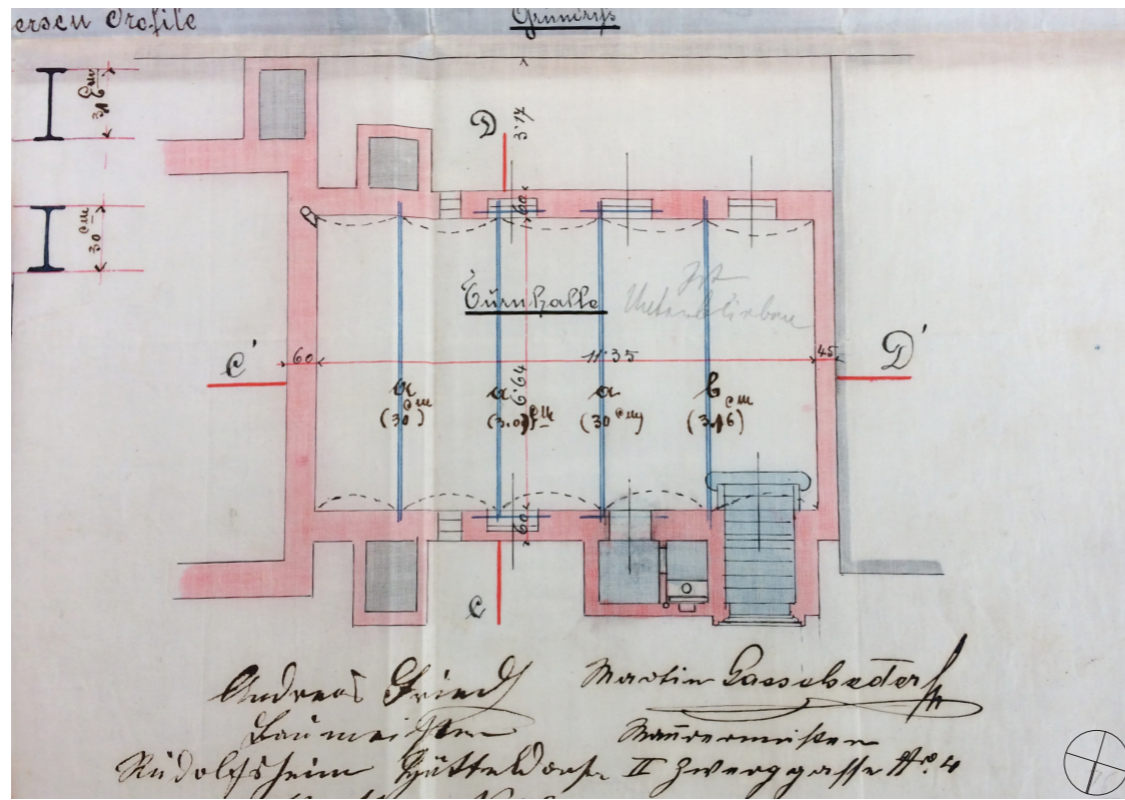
Grundriss Untergeschoß Einreichung (1884) [ma37]
